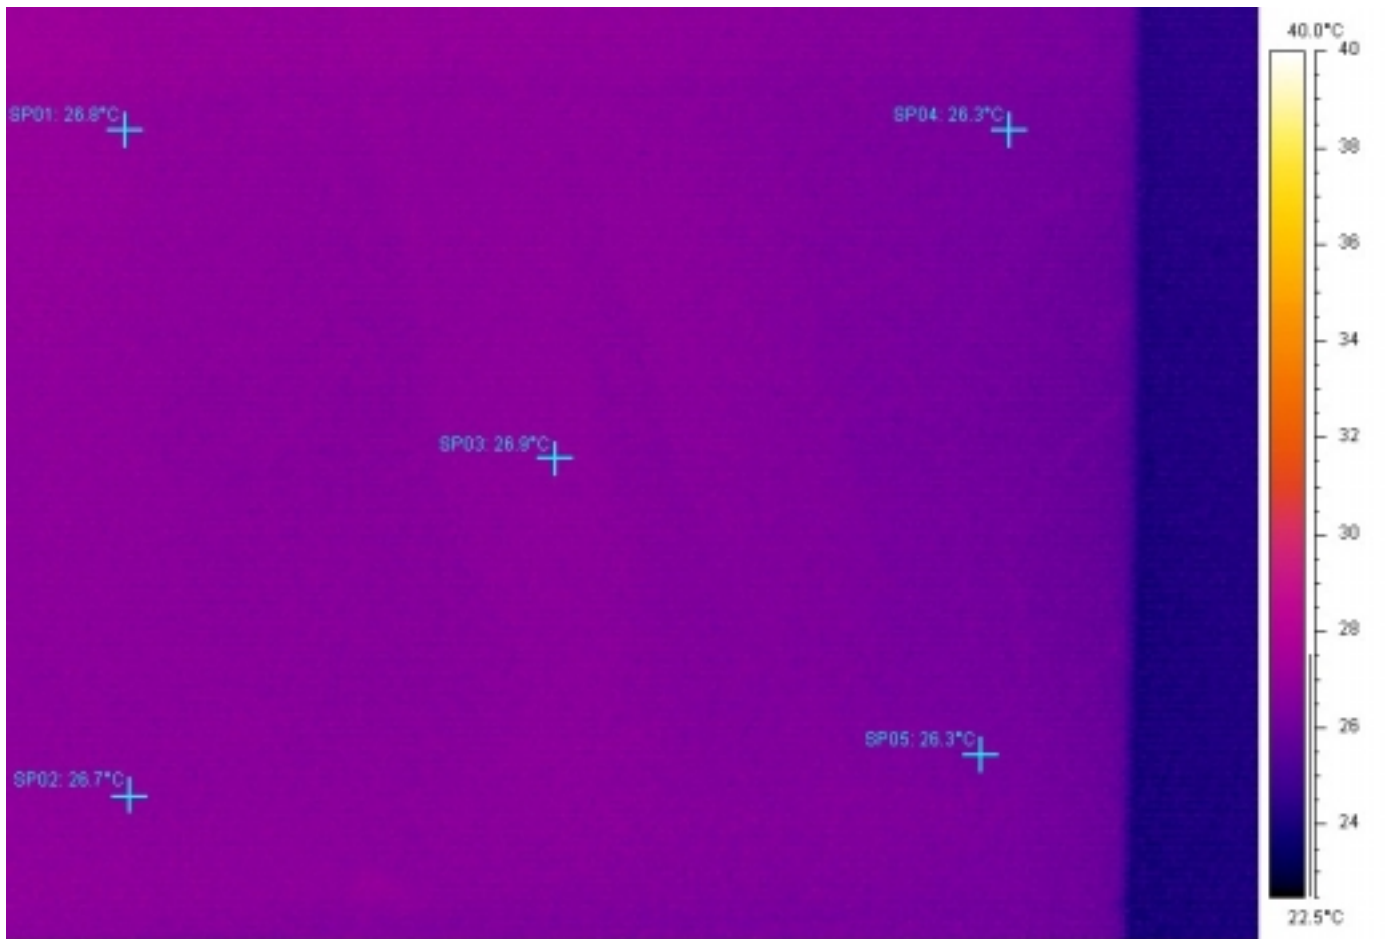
Termograma da parede externa da fachada ventilada na posição (5;2).
